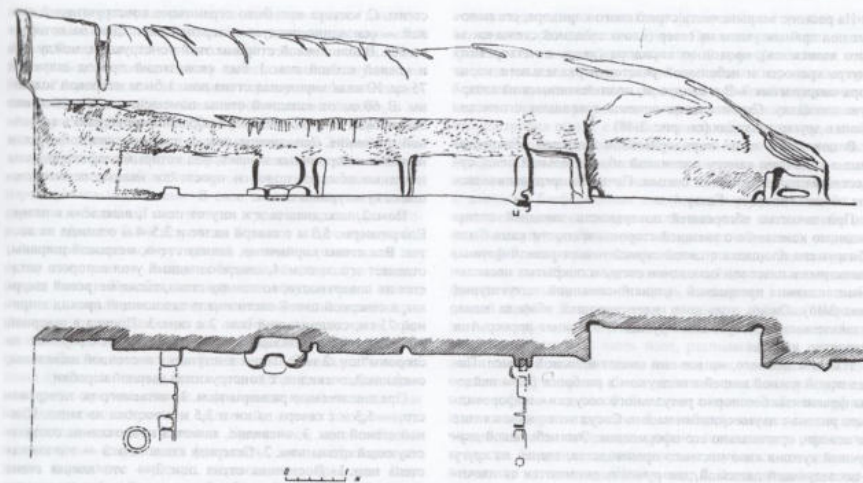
/40. Входной комплекс. Верхняя площадка. План и фасад «культурных» нишек
